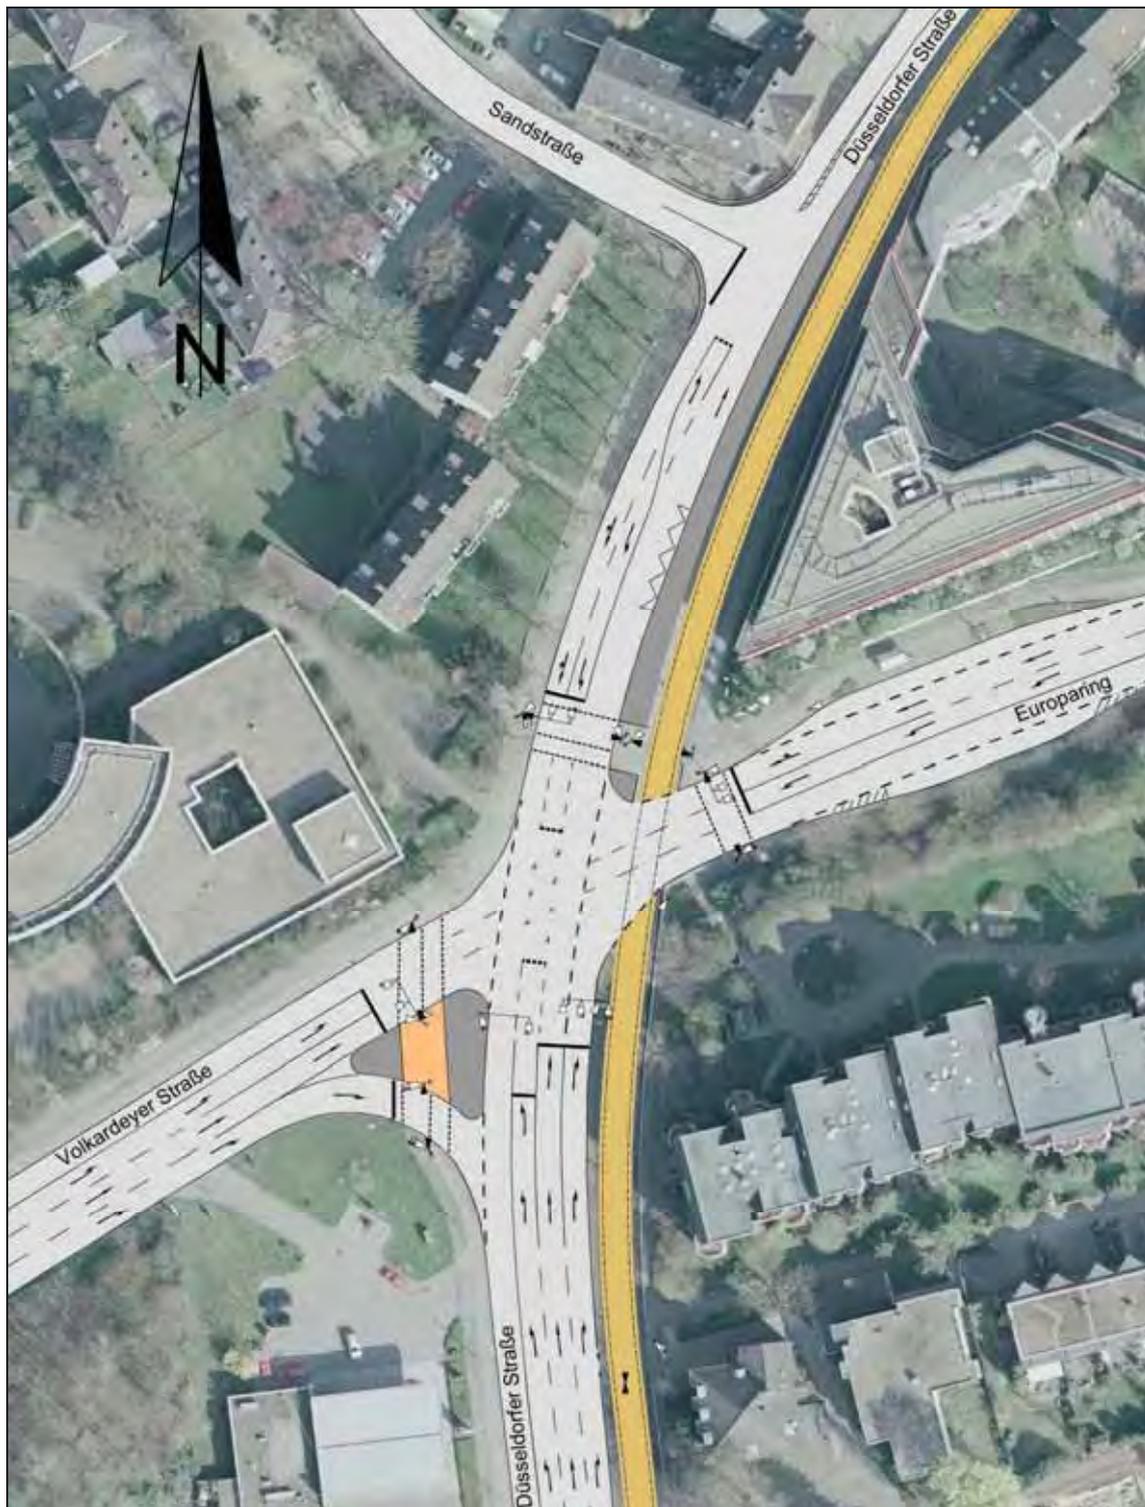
Lageplan für das Knotenpunktsystem Düsseldorf Straße / Europaring / Sandstraße
